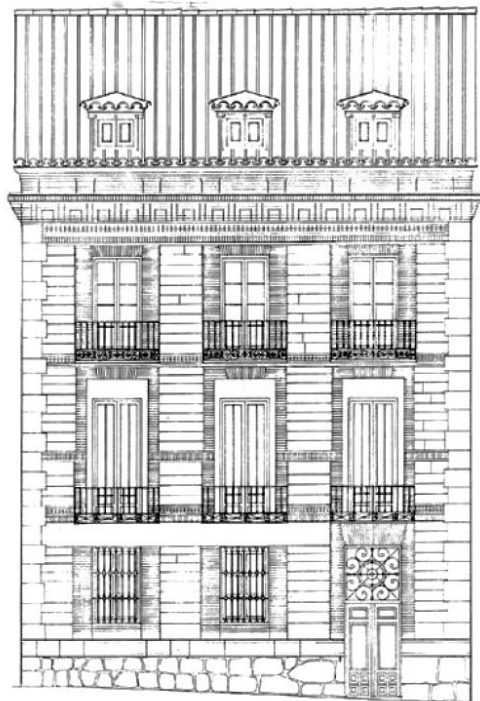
Alzado a Calle Virgen del Amparo 2. Edificio construido
